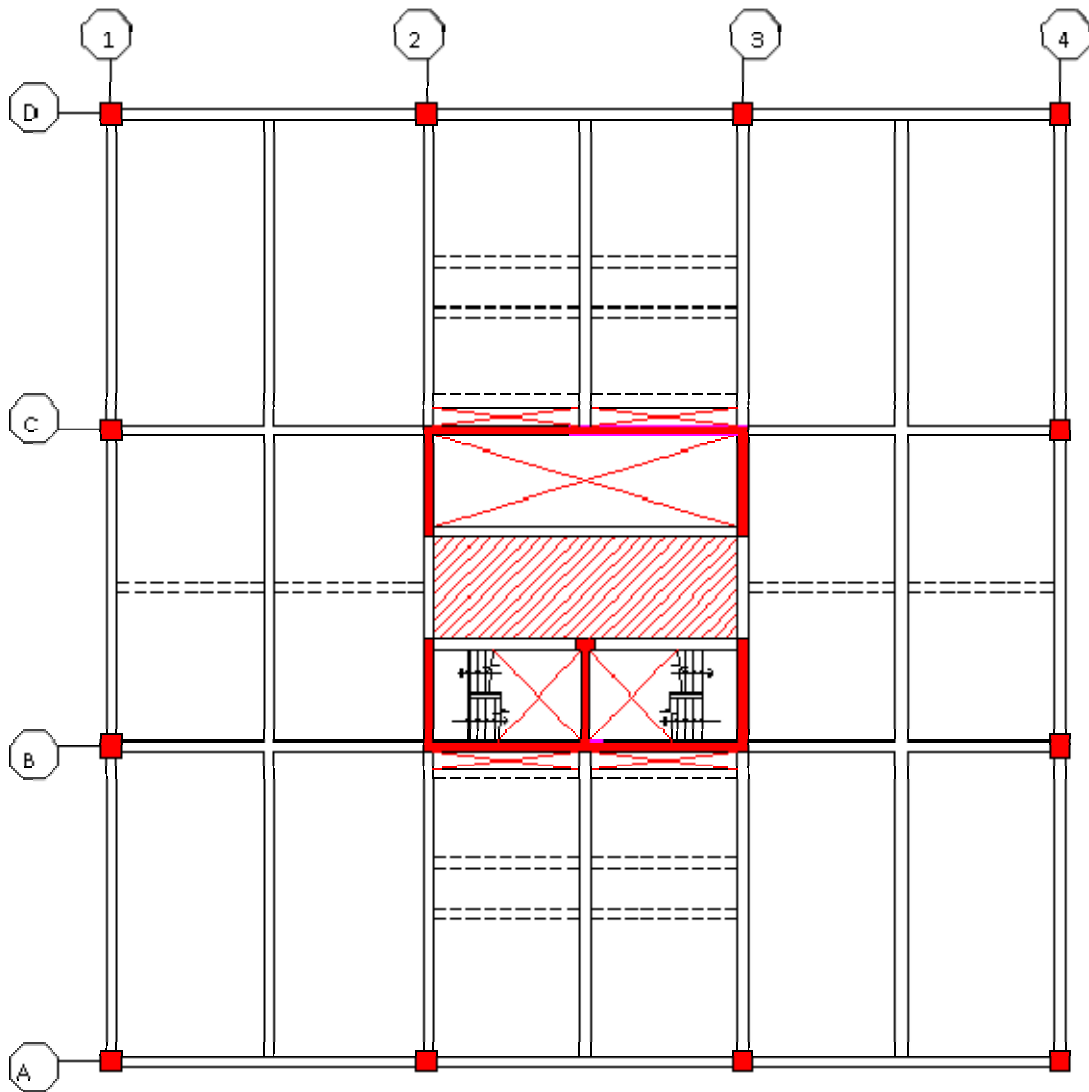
Planta estructural típica del segundo al noveno piso con vigas intermedias.
